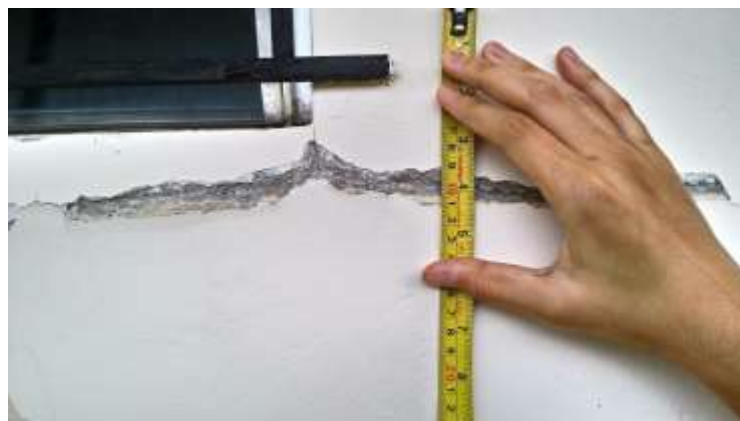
Espesor de grietas en módulo de cirugía
